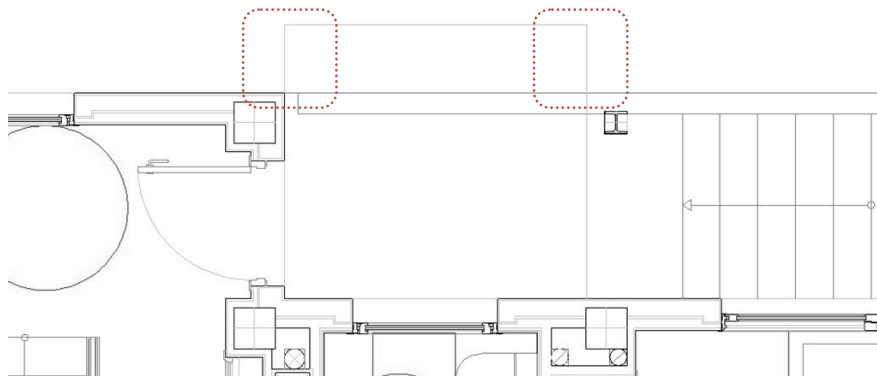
Voladizo en planta del Proyecto en AutoCad. Fuente: .dwg Hadit Arquitectos
